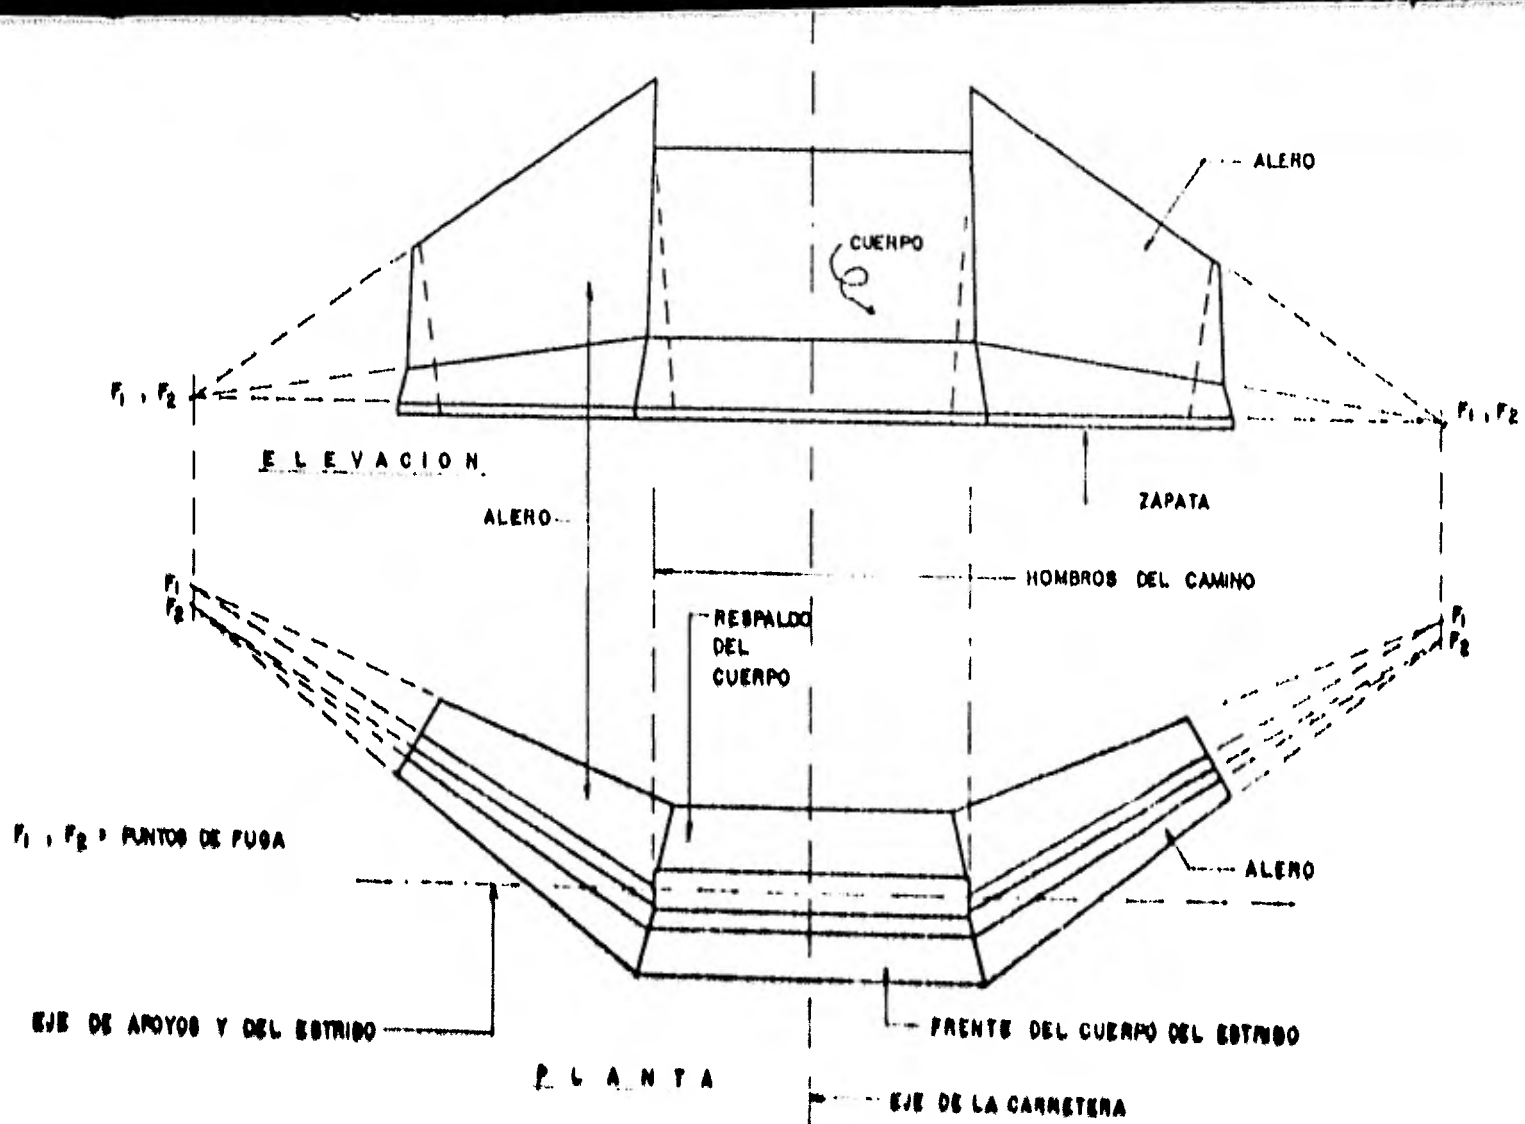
ESTRIBO DE MAMPOSTERIA CON ALEROS
